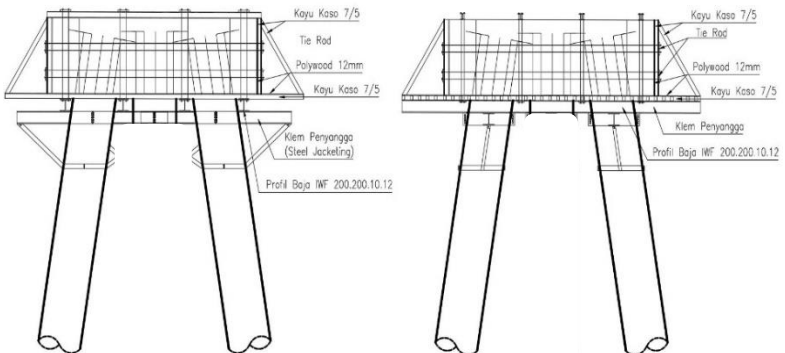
34 Detail Beton Isian Tiang Pancang Pada *Mooring Dolphin
